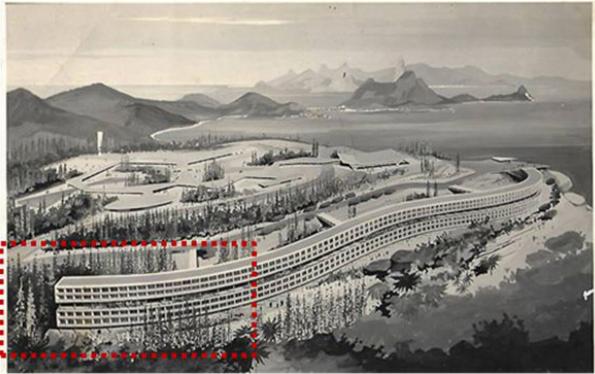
| Perspectiva completa do projeto do Hotel Panorama, com o setor construído demarcado em vermelho, 1959
